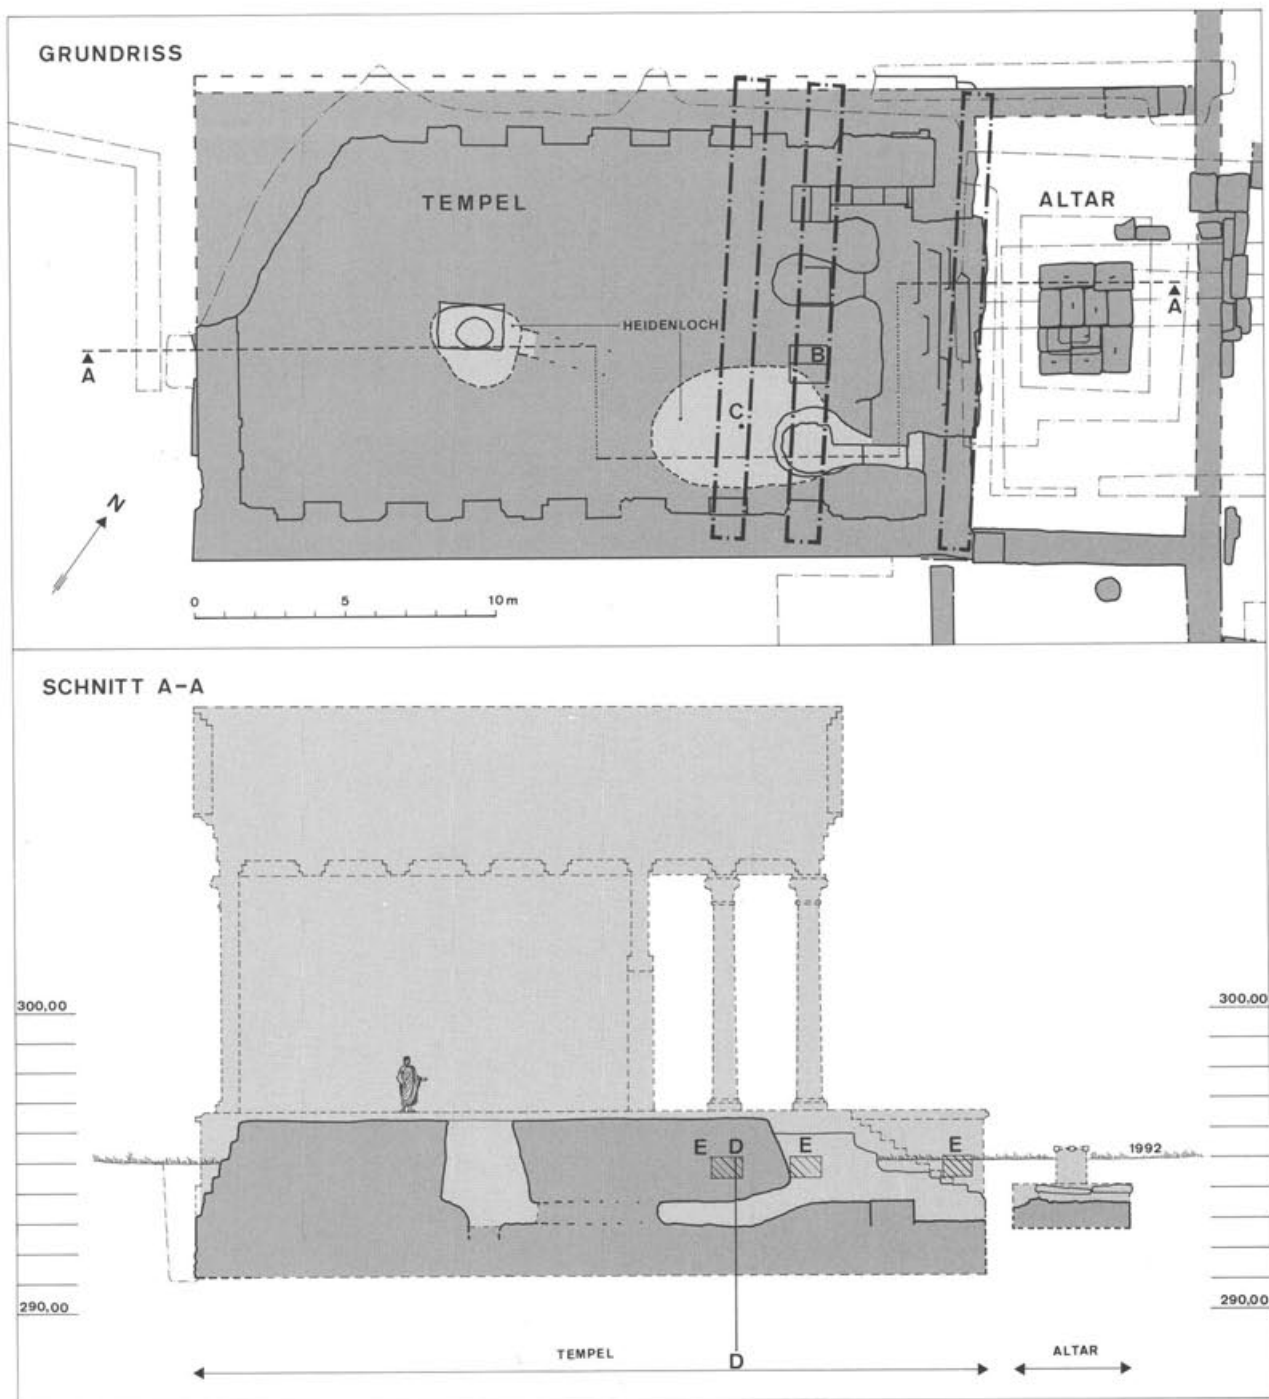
Augst BL, Forum. Tempelgrundriss mit Lage der für die Fundamente der Rekonstruktion der Tempelfront (Abb. 31) angelegten Schnitte. M. 1:250.
